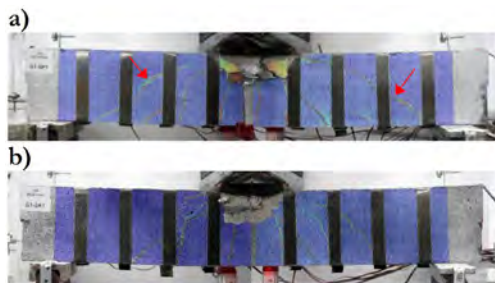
Fisuración de las vigas justo después de la carga máxima. a) Viga SP1: flejes de 25 mm sin activación. b) Viga SA1: flejes de 25 mm activados.
